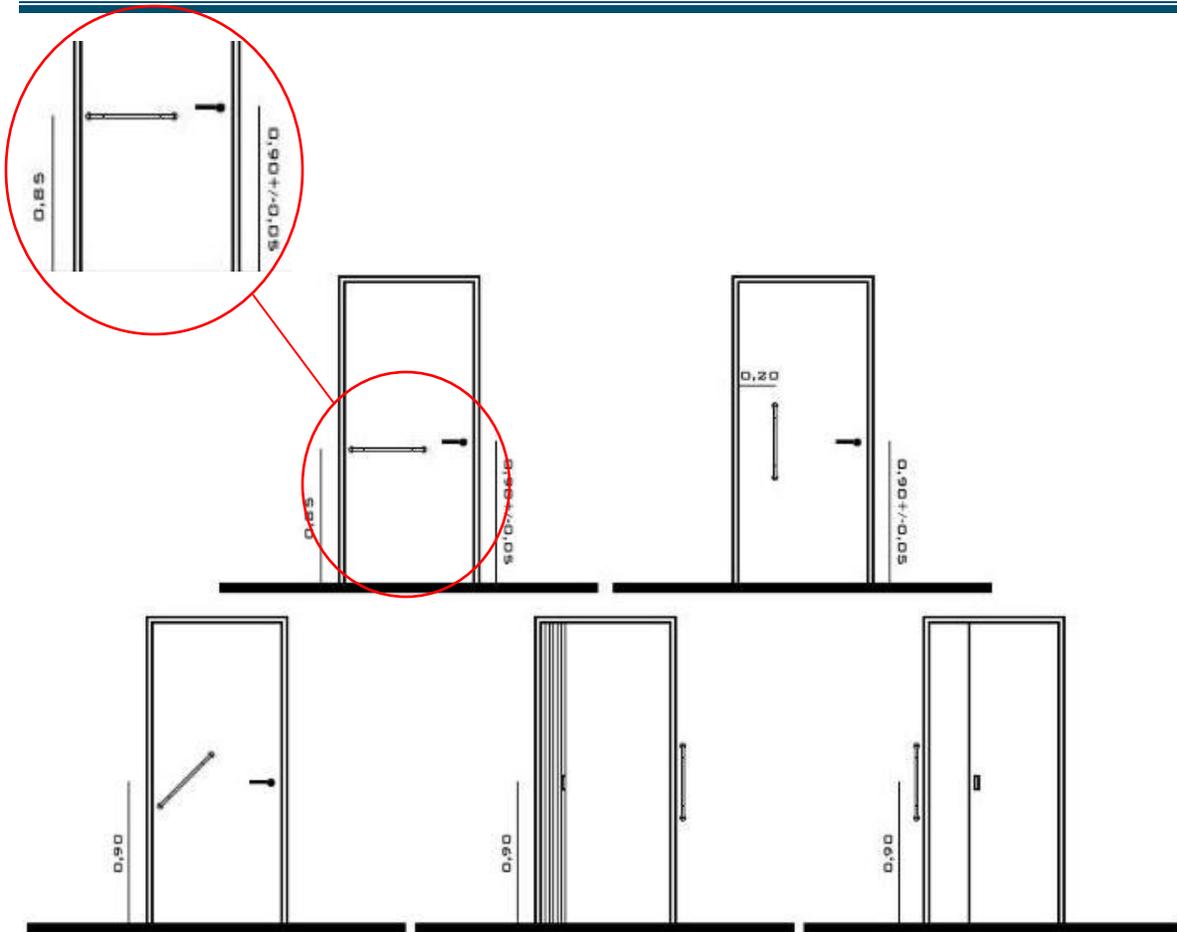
En la imagen se puede observar las recomendaciones al colocar los cerrajes de las puertas.
